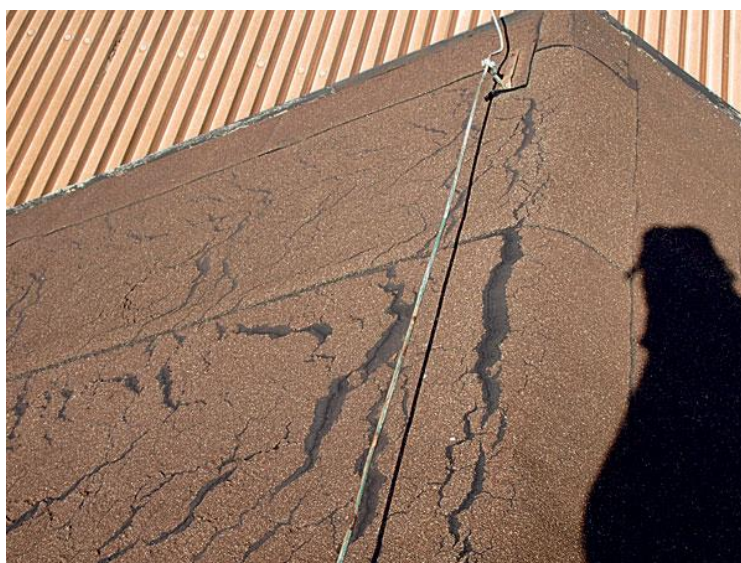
Objemové změny asfaltových pásů (převzato z [2])
